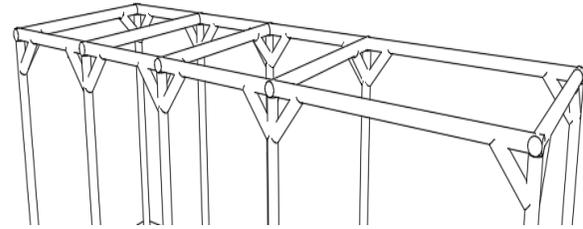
Colocación de traves para baño seco y letrina. Fuente: Elaboración propia
